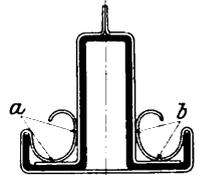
Rinneneisen mit Federklammer. Deckschienenhalter und Lagerleiste.
